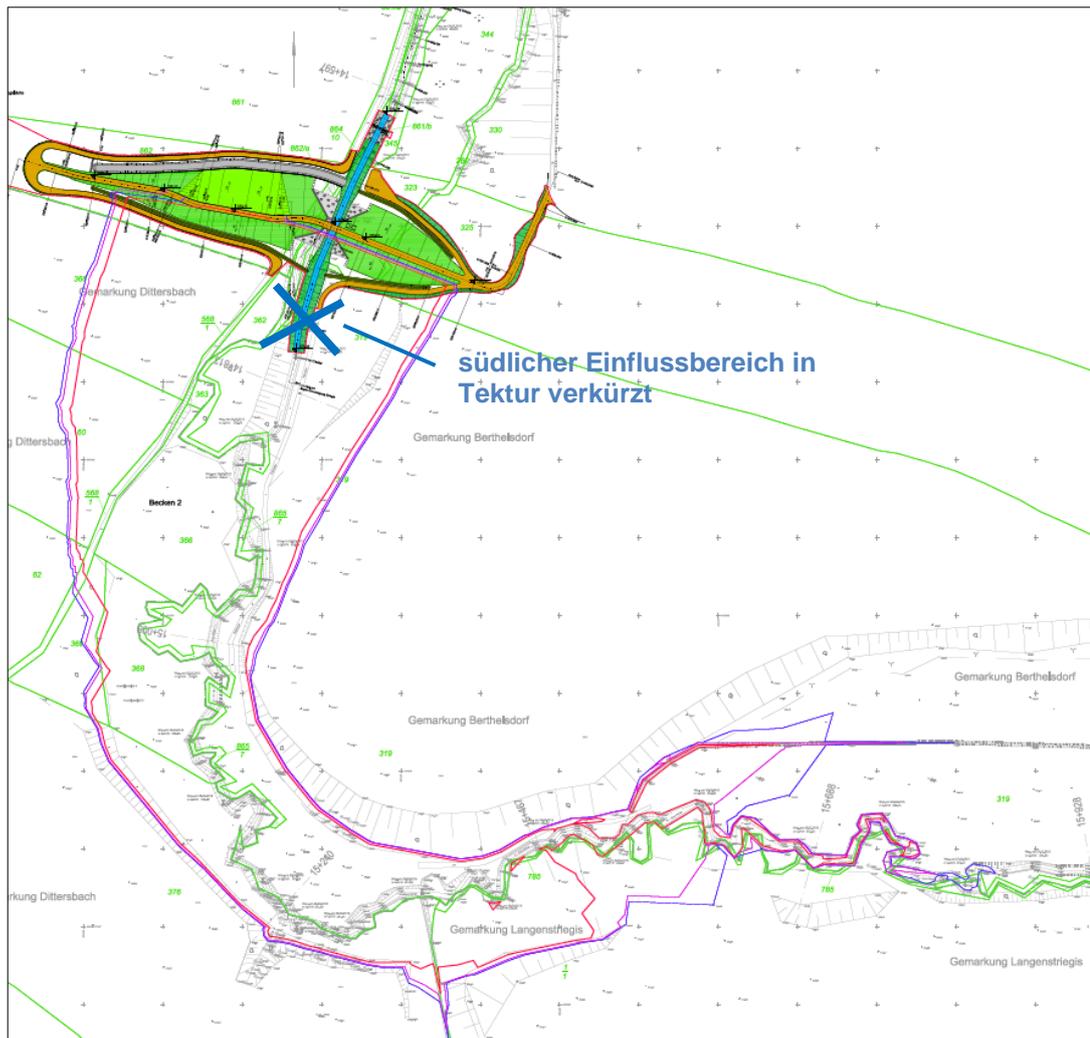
Planung Absperredamm Beckenstandort II neu mit Einstauflächen, Plan Nr. 3 (ICL/ Klemm & Hensen)
